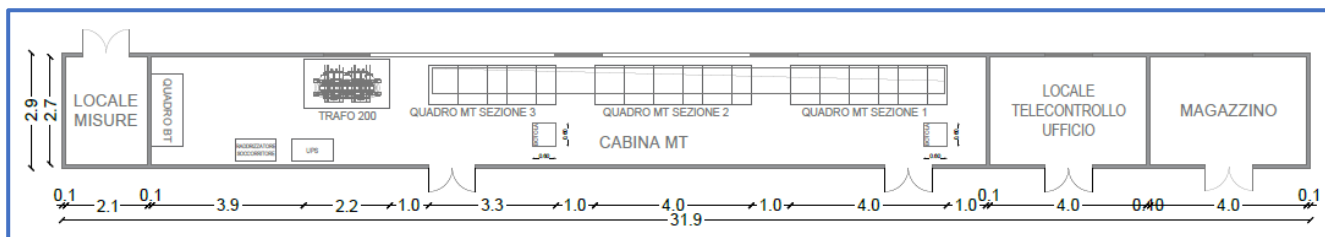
Vista in pianta della cabina MT e locali di servizio
